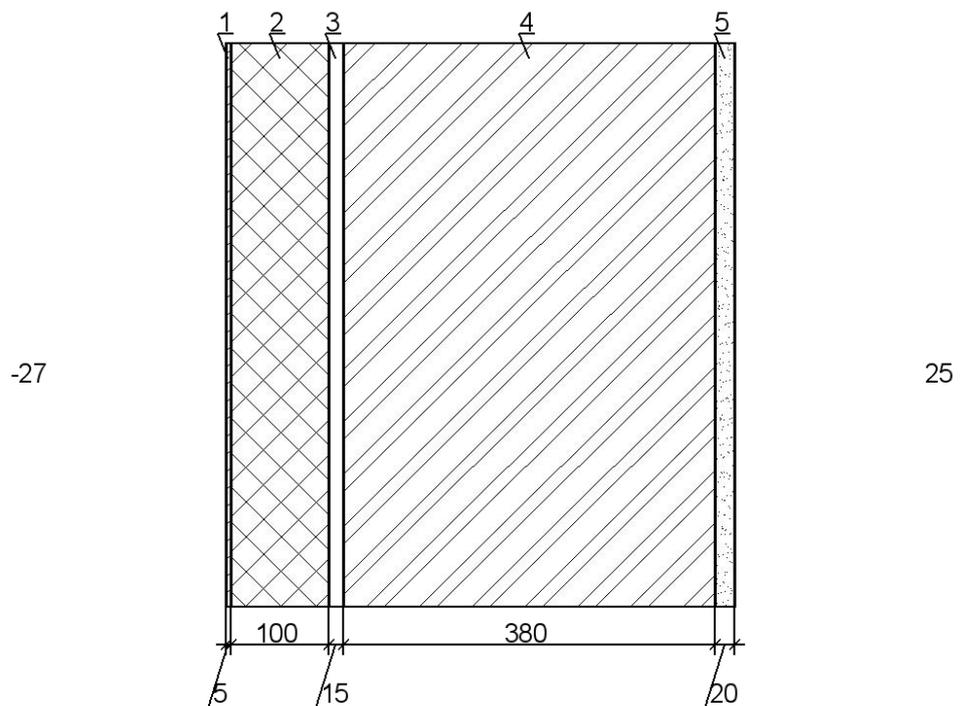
Схема конструкции ограждающей конструкции стен.
